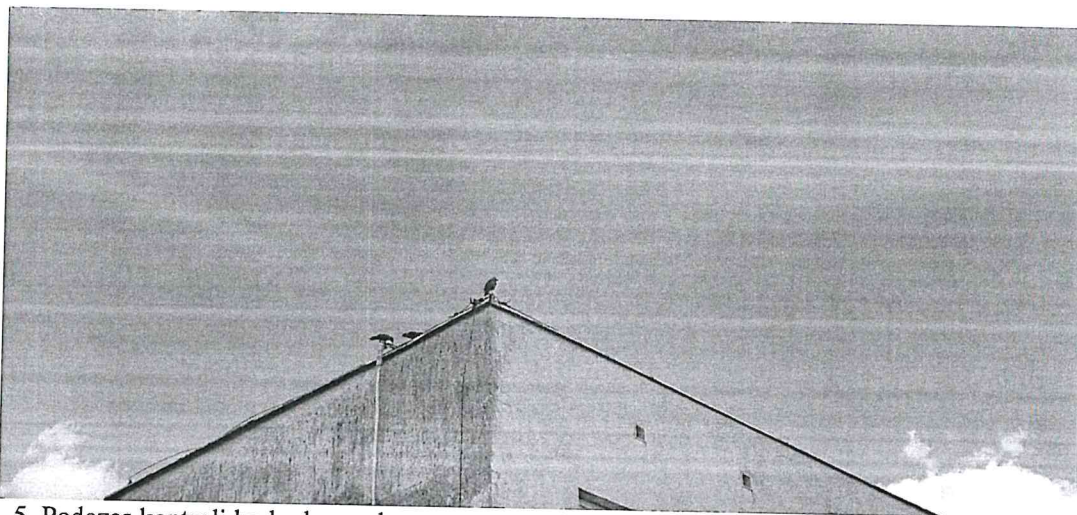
Zdjęcie elewacji wschodniej kontrolowanego budynku.
